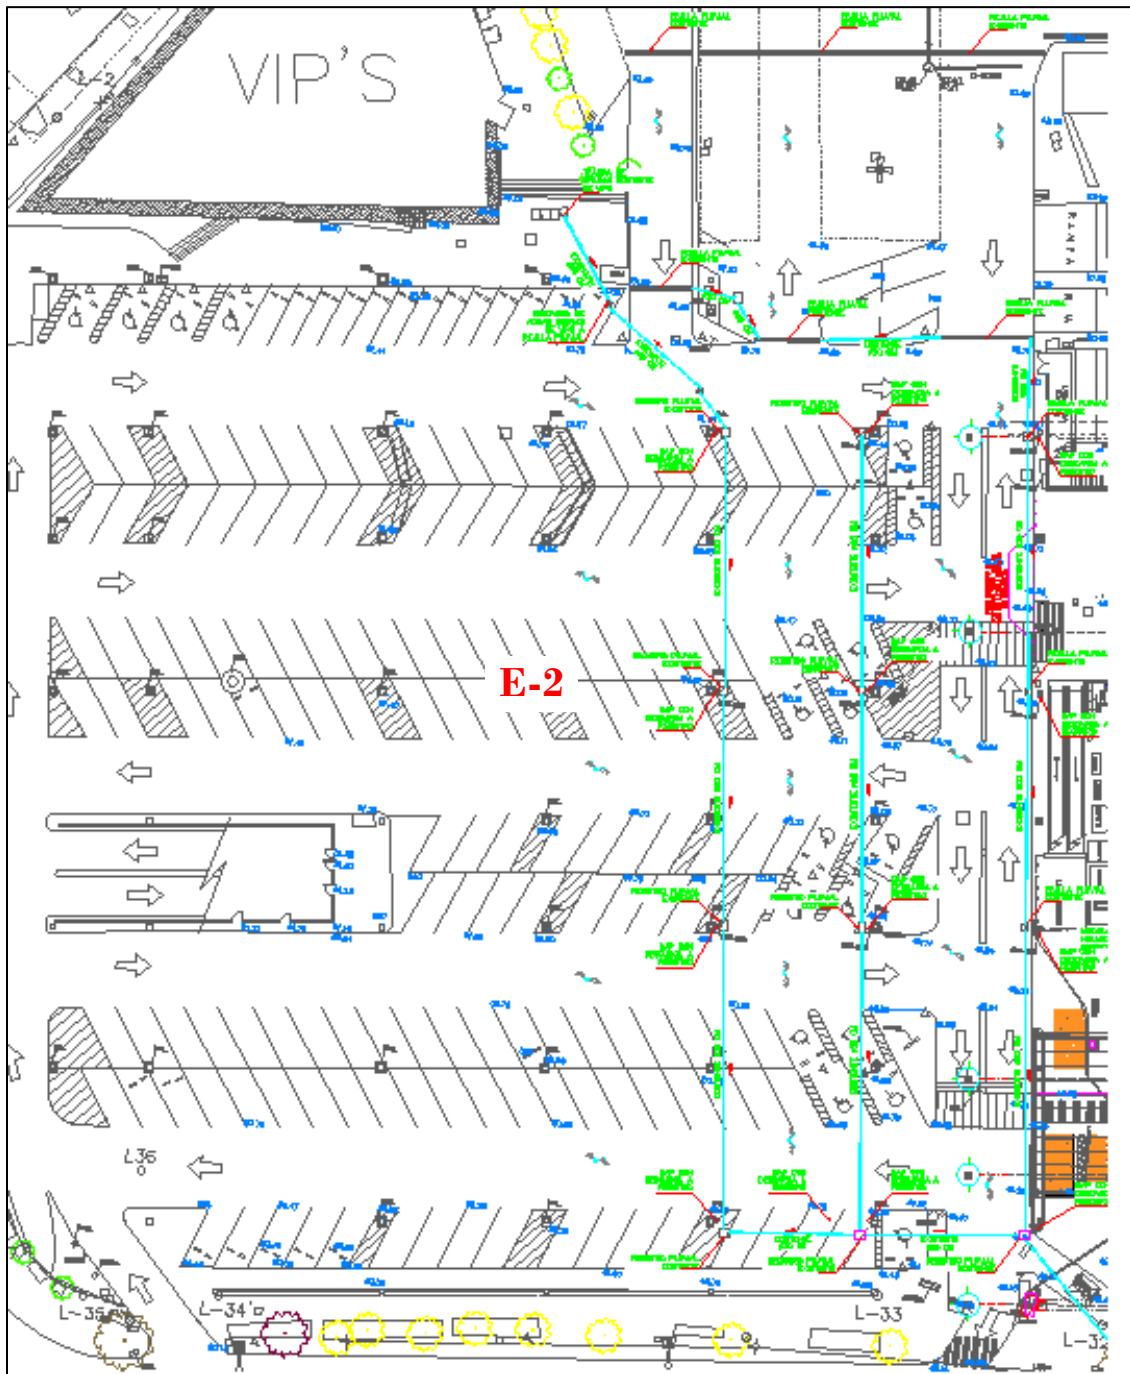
Estacionamiento planta baja (vista en planta).
